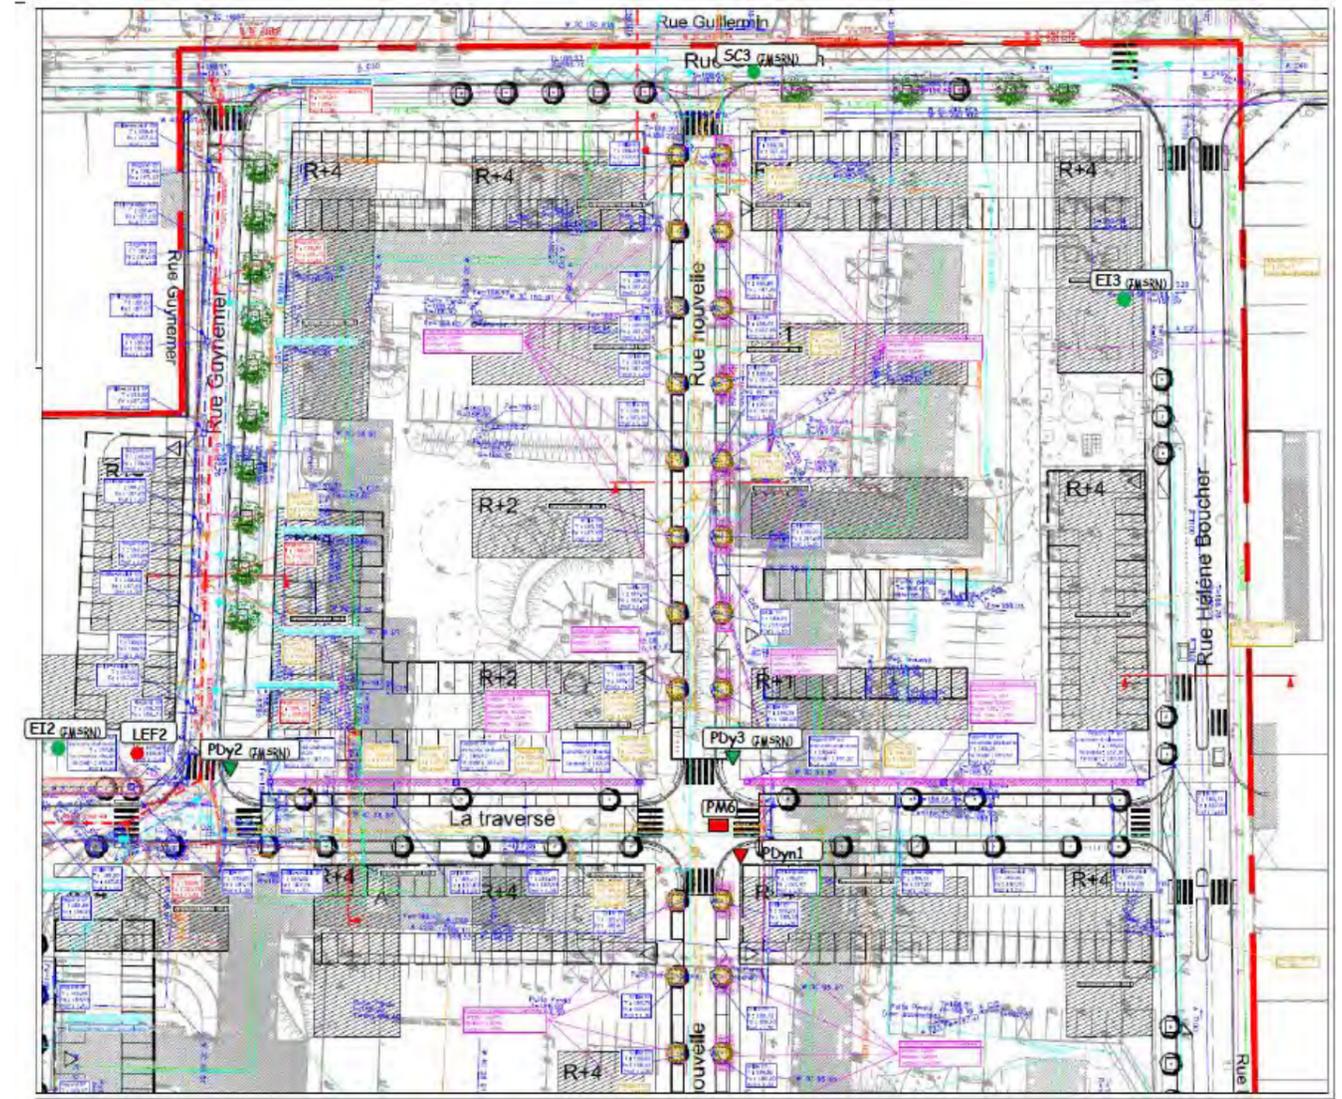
Plan d'implantation des sondages de l'étude FONDASOL d'avril 2017 – secteur Nord
